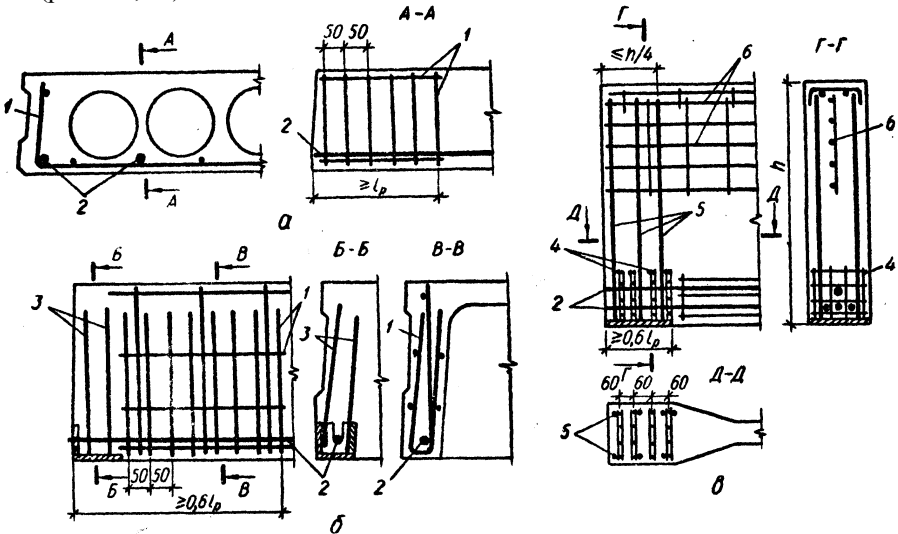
Арматура кінців попередньо напружених плит та балок:
